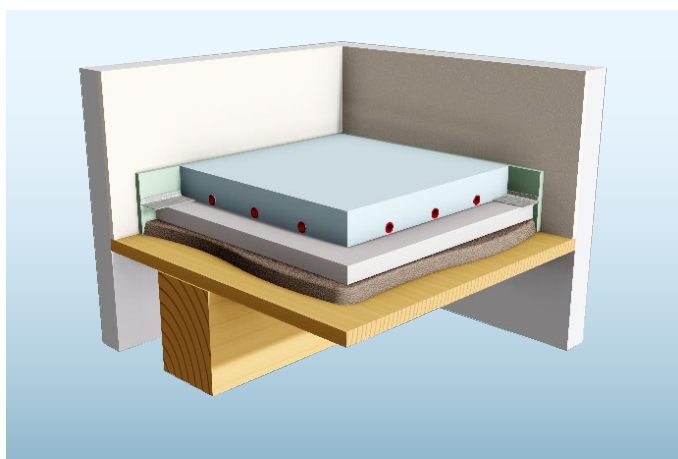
Estrich auf Holzbalkendecke mit Fußbodenheizung
